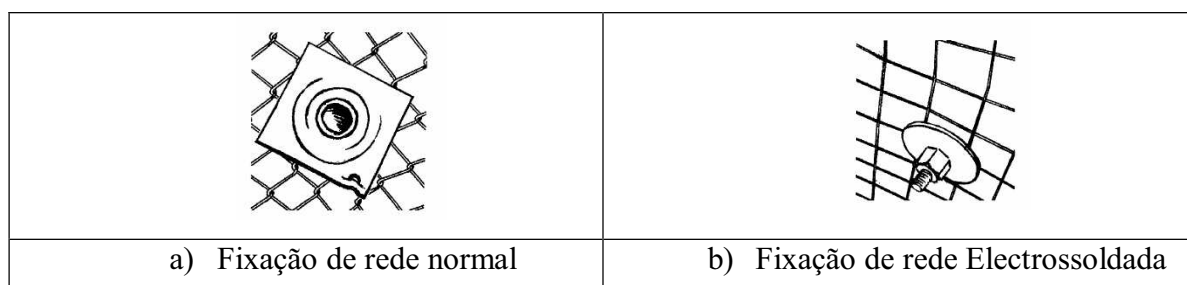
Aplicação de redes metálicas (Guerreiro, 2000).
